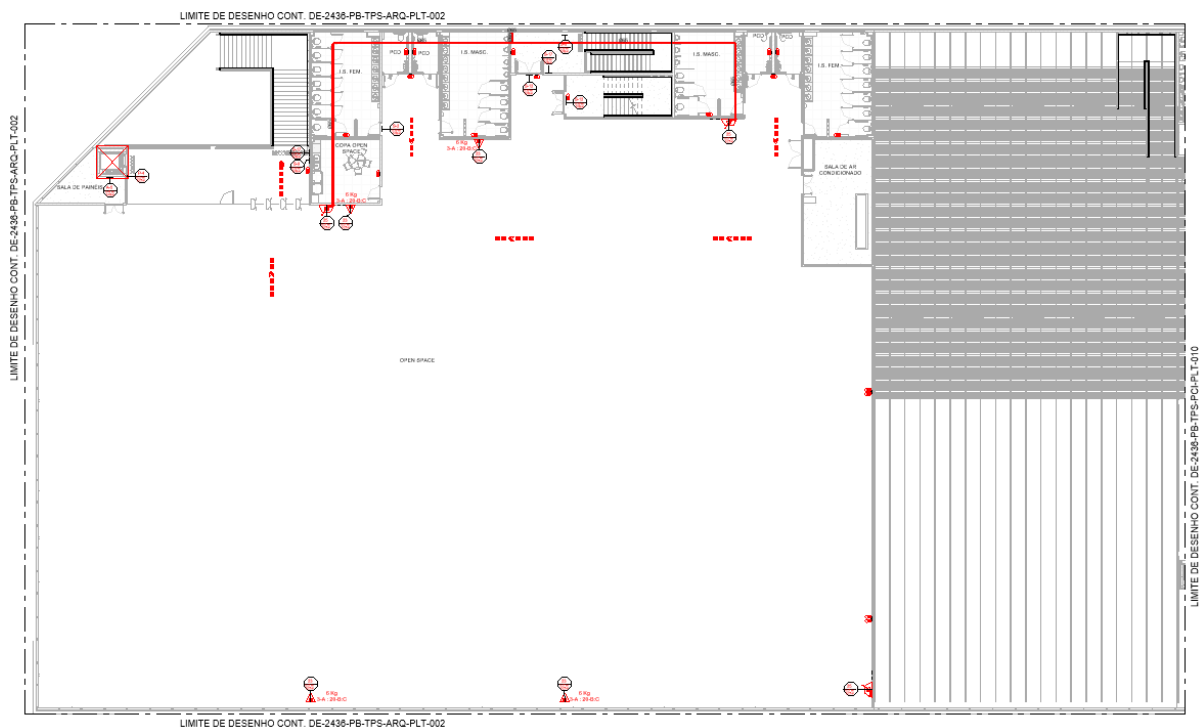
Arranjo dos hidrantes, extintores e sinalização no primeiro pavimento lado oeste (Open Space).
